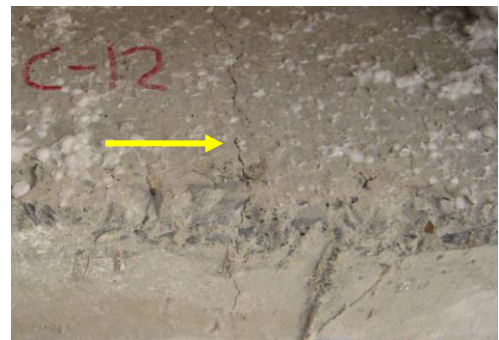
Fisuración en viga por flexión y/o deformación excesiva
